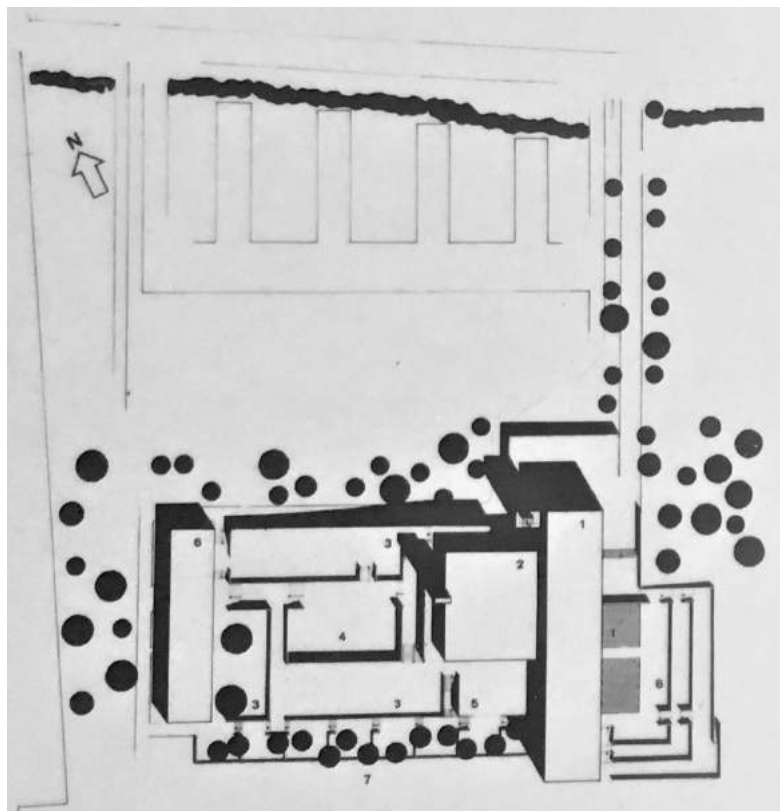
Lageplan Ausflugsrestaurant Bellevue, 1963
